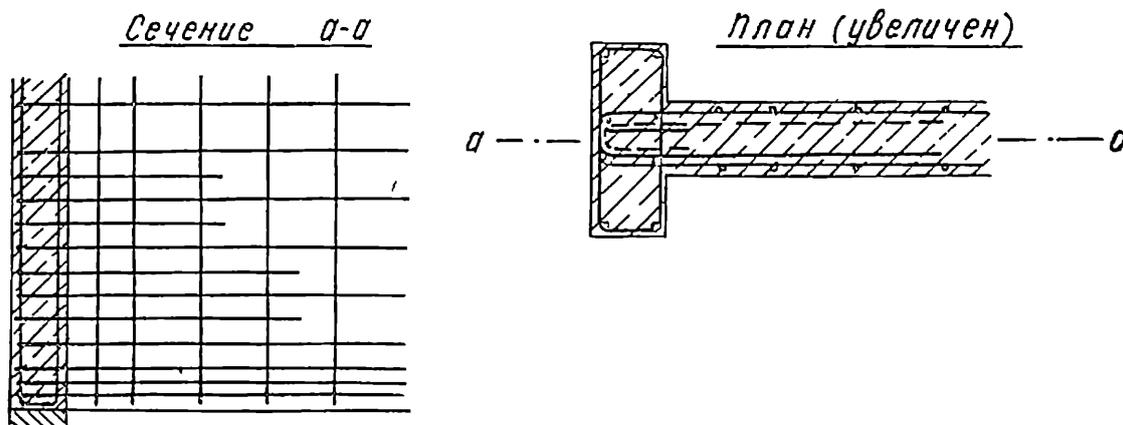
3. Армирование в зоне опирания балки-стенки (по рис.2.5 - 2), концы которой усилены при помощи пятастр или утолщений
